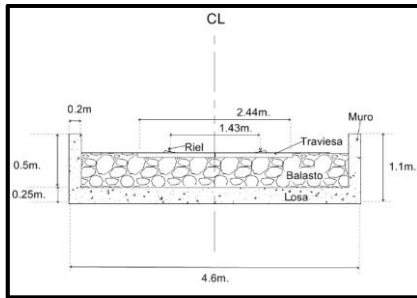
Sección típica del puente ferroviario, para un solo tren. Fuente: Autores
